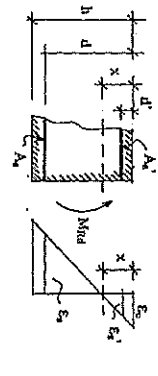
Flexão normal simples de uma viga de concreto armado
